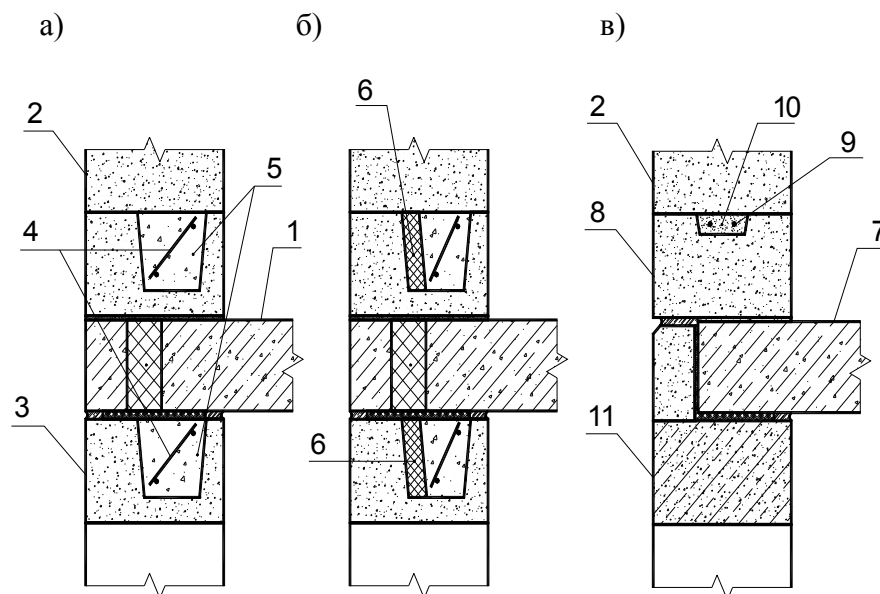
Горизонтальное армирование однослойных поэтажно опертых стен
